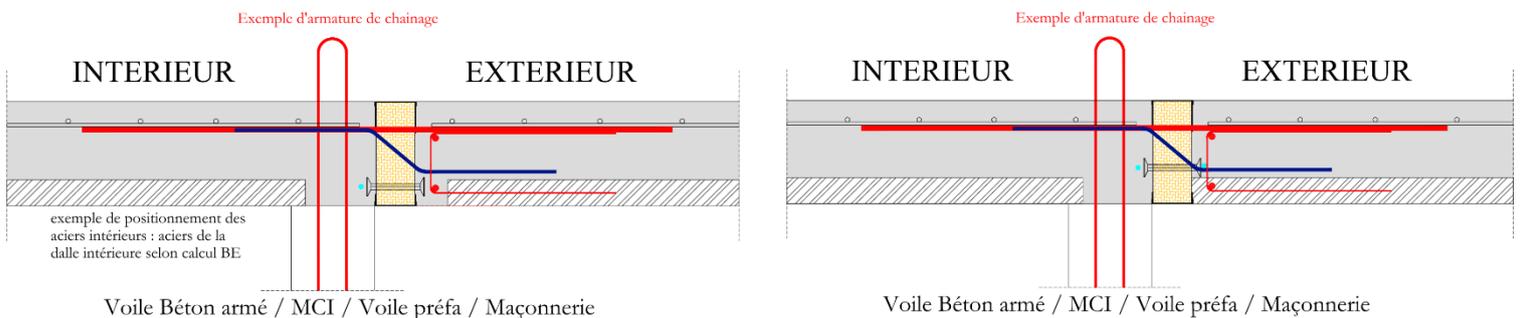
détail final après coulage de la dalle, à gauche dans le cas d'un décalage de la prédalle, à droite dans le cas où la prédalle est positionnée au nu du rupteur
